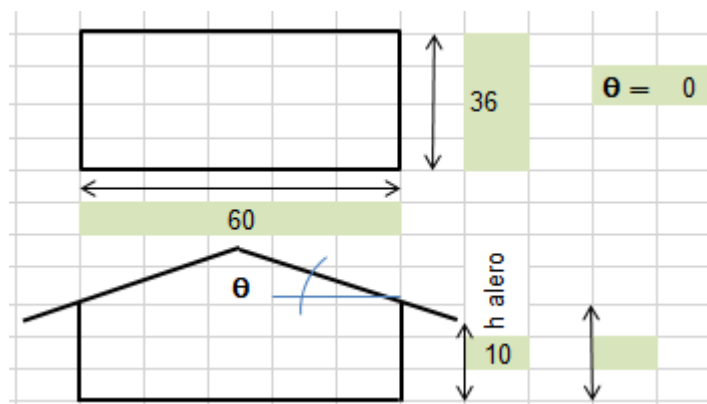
| Dimensiones de la estructura en el cálculo del viento
